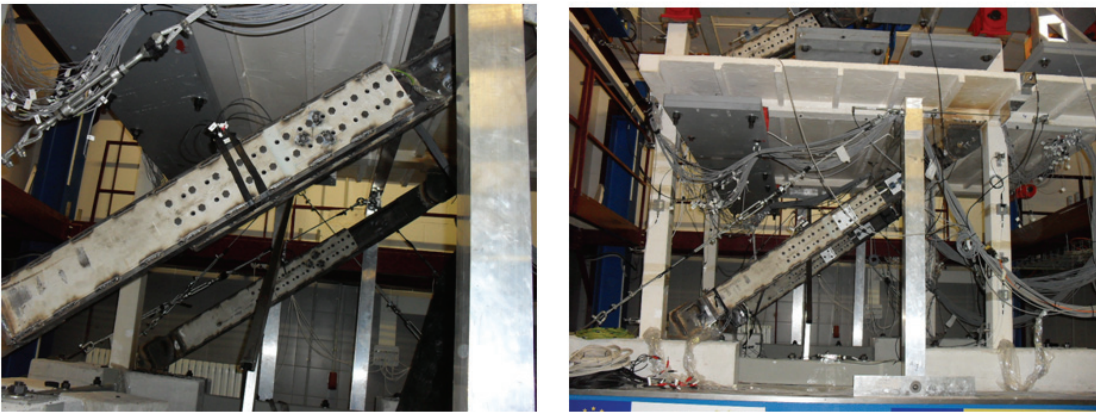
Imágenes de los disipadores WPD con secciones-I instrumentadas con sensores PZT instalados sobre la estructura porticada
